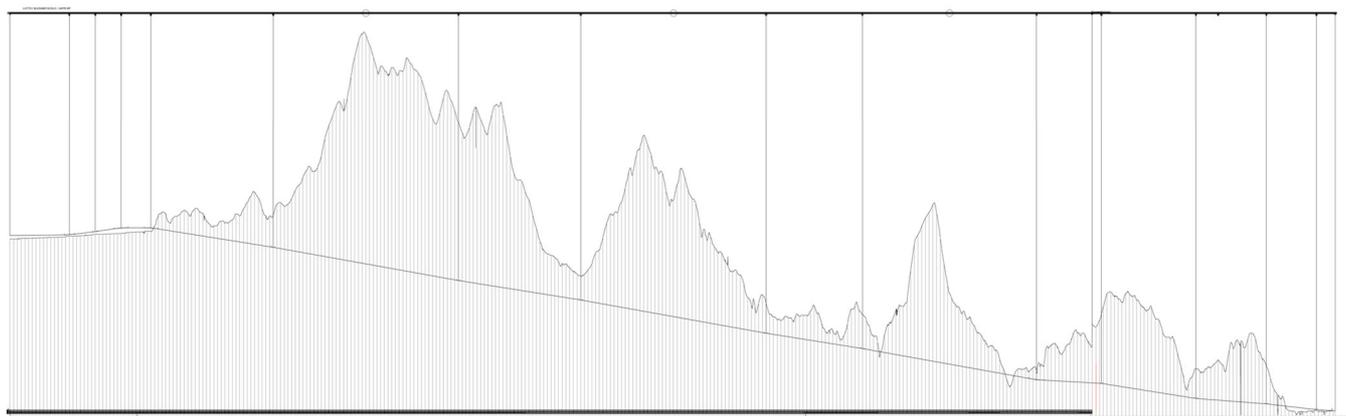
Profilo piano-altimetrico dell'alternativa di tracciato B
